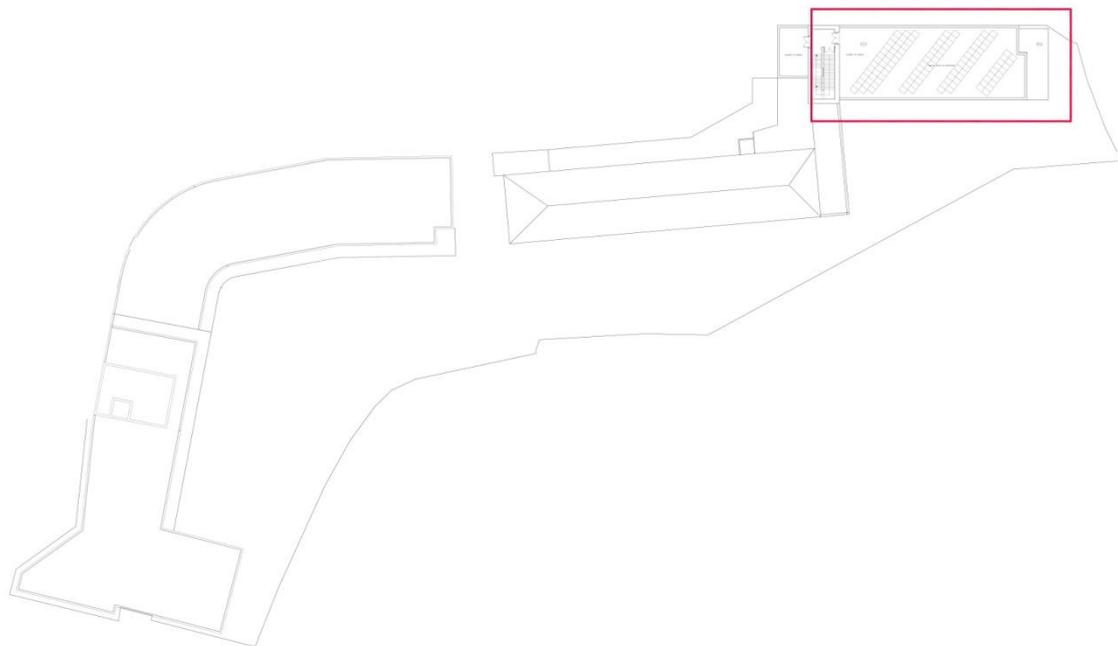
Col·legi Sant Roc - Planta Cubierta
